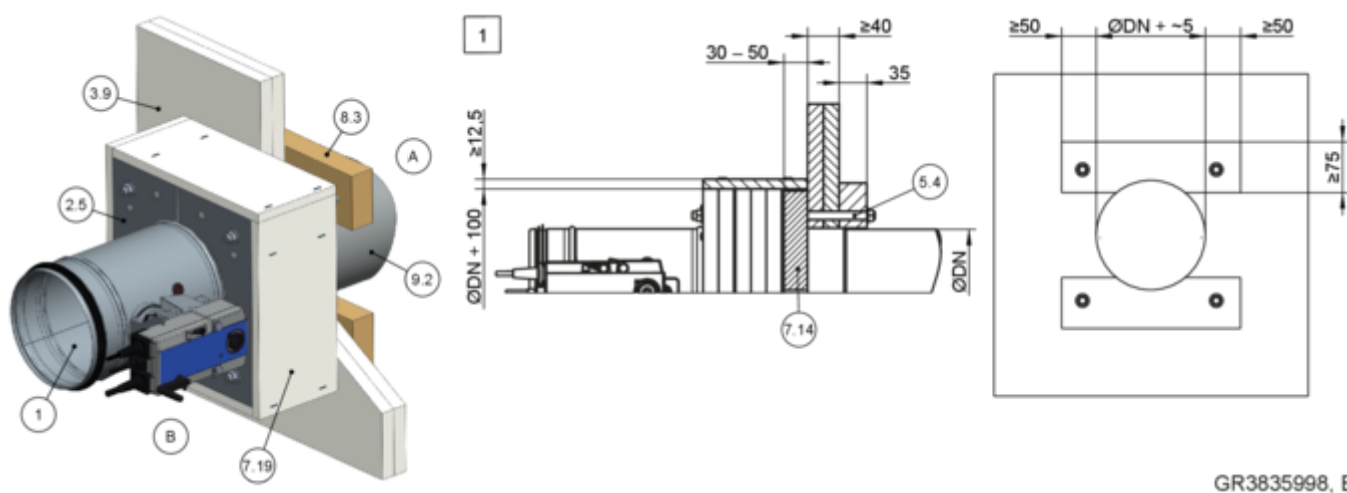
Montaż bezzaprawowy w ścianie szachtu bez metalowej konstrukcji szkieletowej, z zestawem montażowym TQ2
